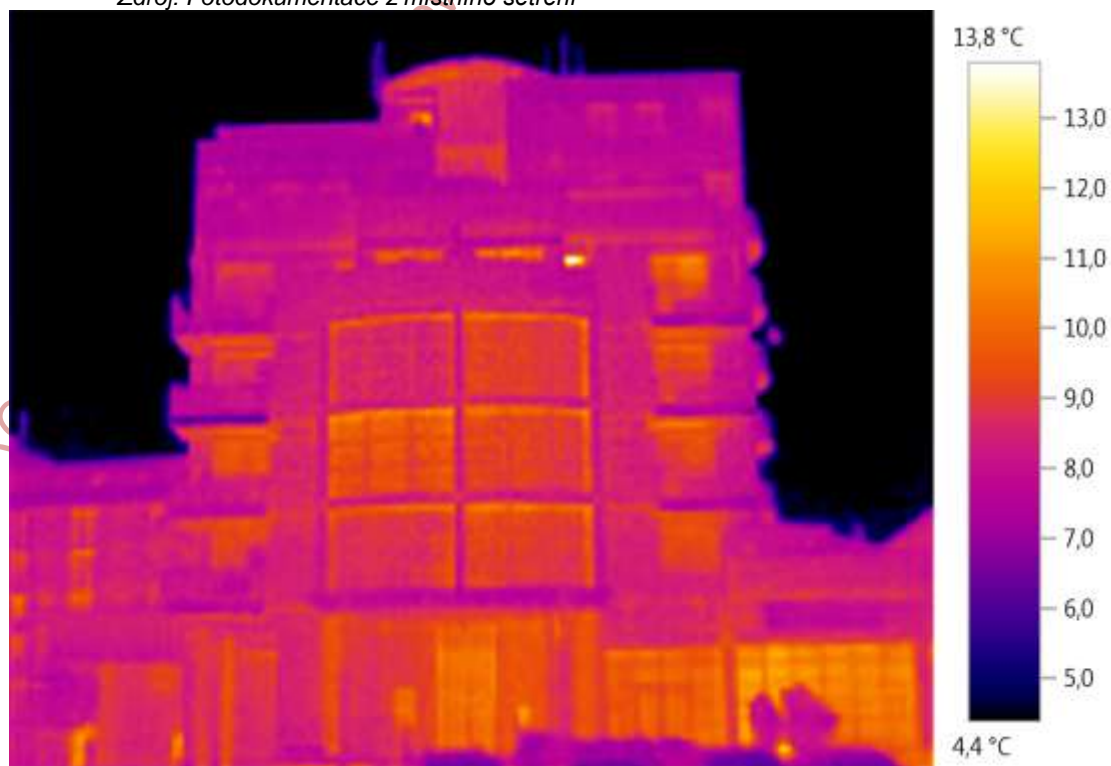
Jižní fasáda. Termovizní snímek dokumentující zvýšenou povrchovou teplotu fasády v místech železobetonových stropních ztužidel, sloupů skeletu, ale i vykrakorcovaných balkónů
